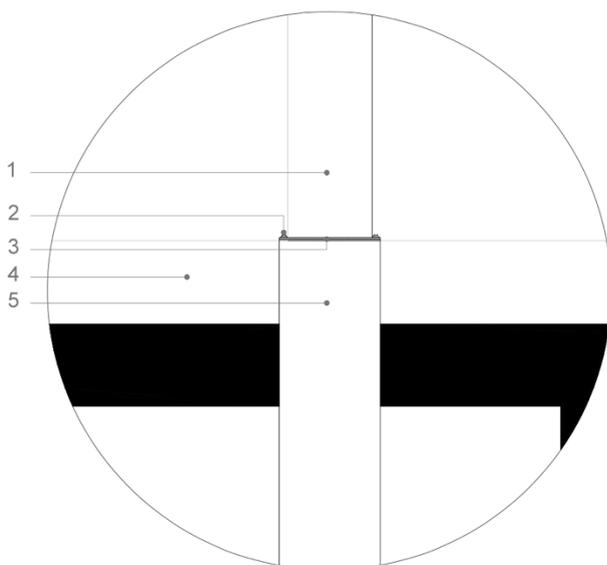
Detalle de unión columnas metálica y hormigón. Elaboración propia.
